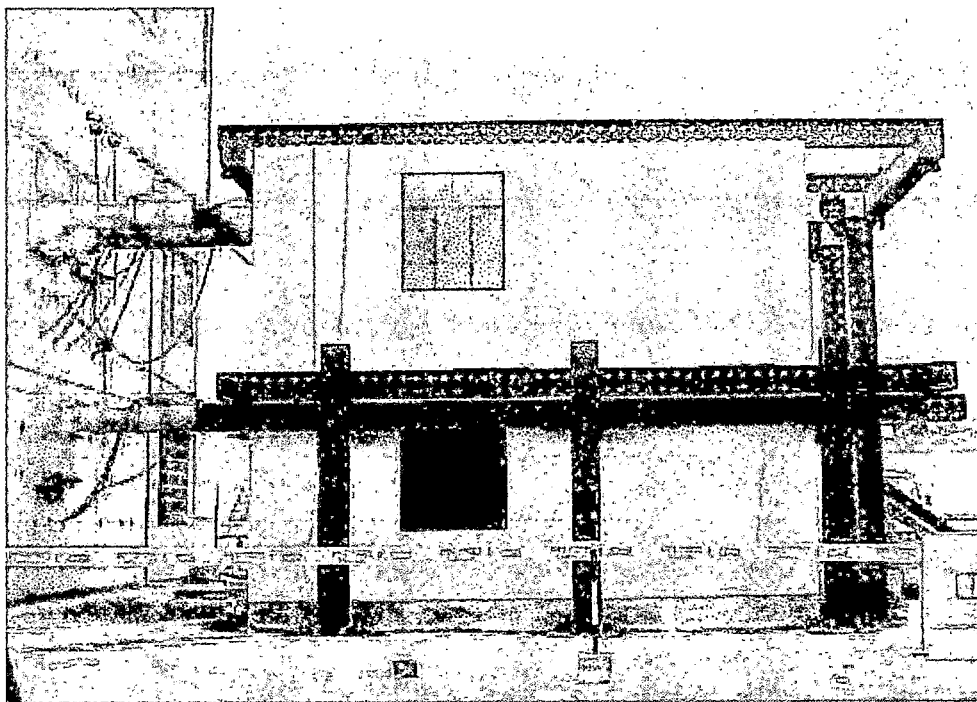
Vista de perfil de la vivienda con el kit de montaje, nótese la ubicación de los actuadores.
